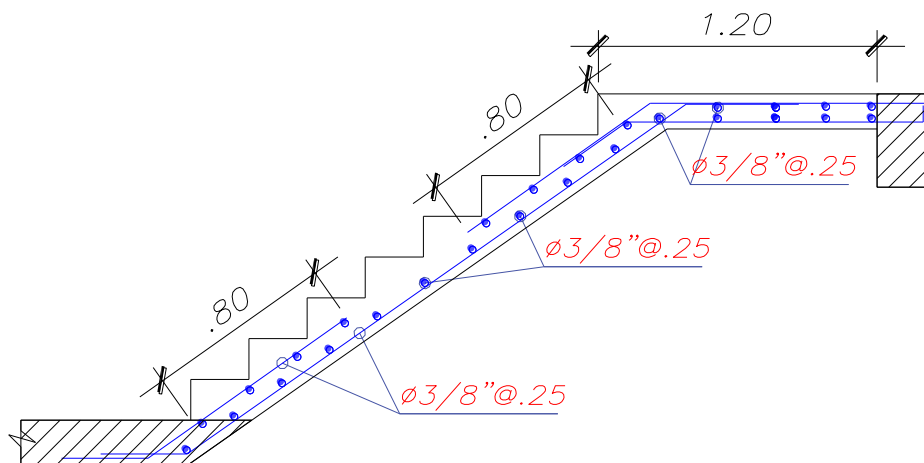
Detalle del Acero en la escalera típica (tramo 1)
